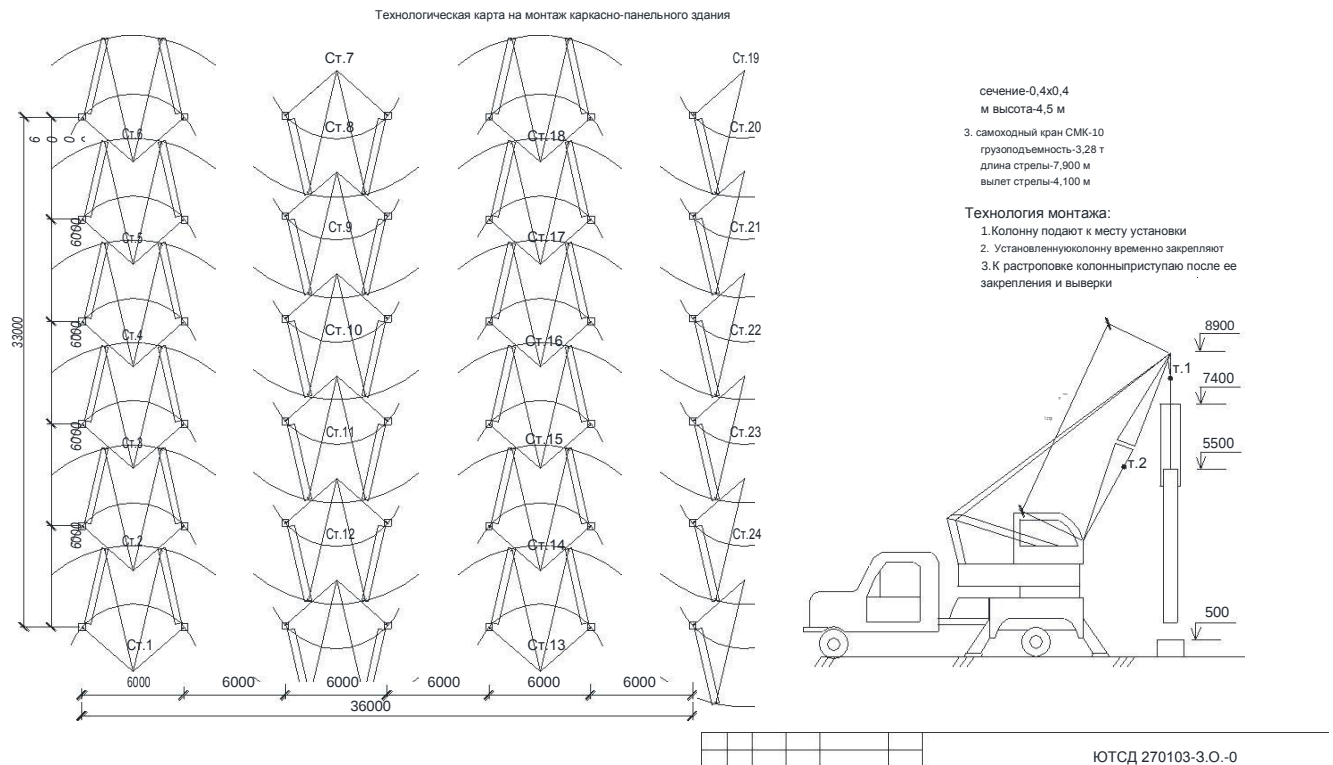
Пример выполнения схемы монтажа каркасно-панельного здания
